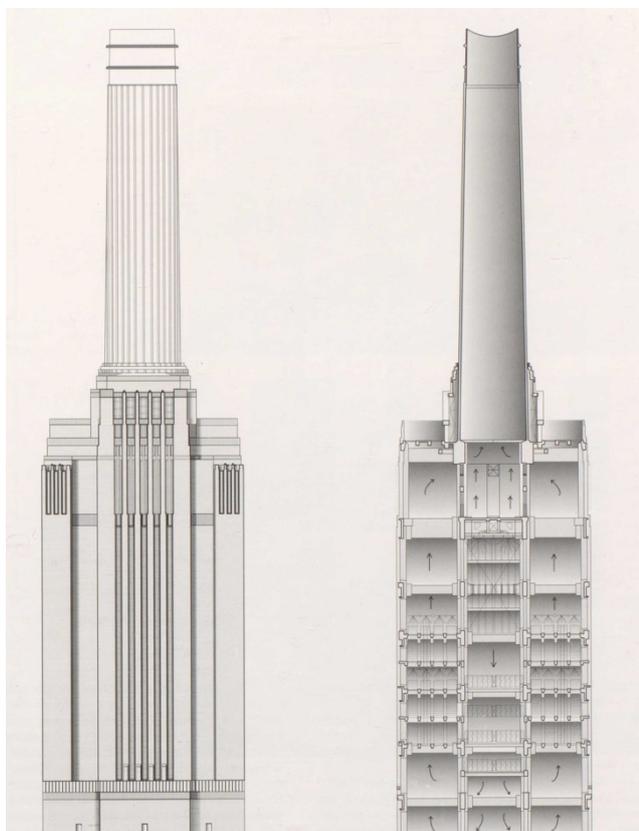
, Battersea Power Station, prospetto e sezione angolare della torre e delle ciminiere
